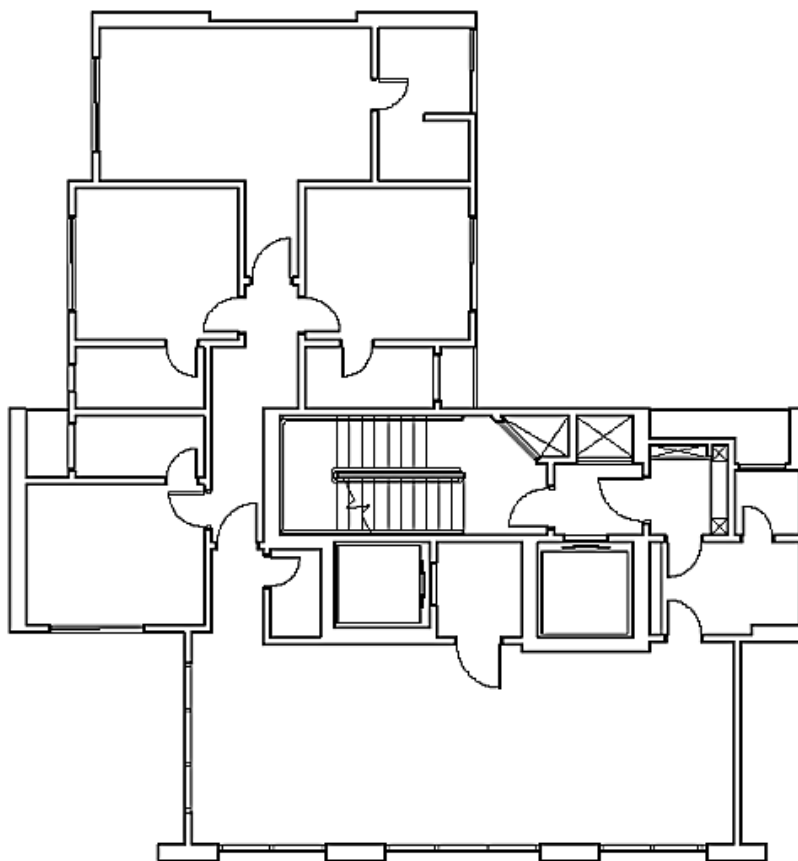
Planta baixa do pavimento utilizado no estudo.
